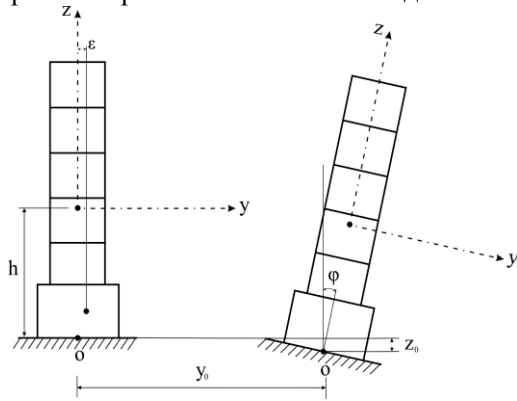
Разрез здания, сопровождающегося одновременно поворотом, сдвигом и вертикальным перемещением
